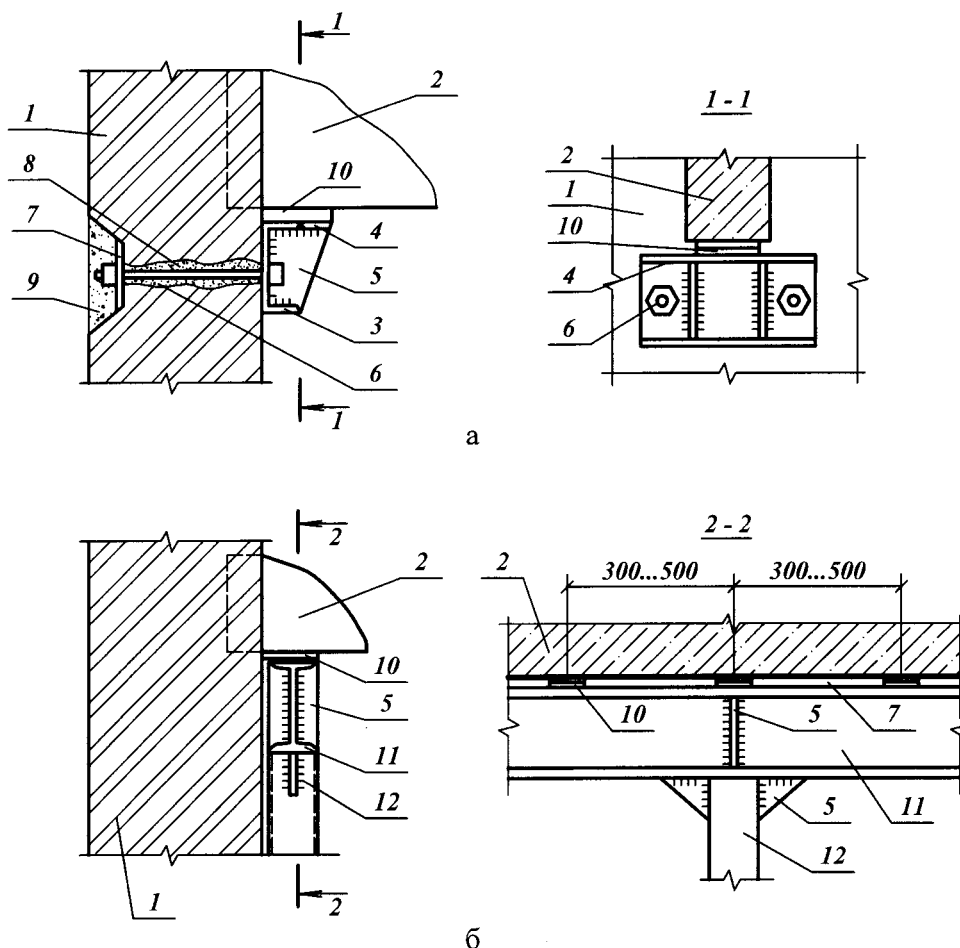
Усиление узлов опирания балок и плит на элементы каменных конструкций: а – установкой стальных столиков; б – подведением балок на стойках; 1 – стена; 2 – несущая балка или плиты, не имеющие достаточной длины опирания на стену; 3 – опорный столик из швеллера; 4 – дополнительная пластина, приваренная к полке швеллера; 5 – ребра жесткости; 6 – анкерные болты; 7 – пластины-шайбы; 8 – отверстия в стене (заполняются цементно-песчаным раствором после установки болтов); 9 – ниша в стене (заполняется раствором); 10 – стальные пластины-клинья для включения столиков (балок) в работу; 11 – балка-опора из двутавра $\text{I}12\dots20$; 12 – стойки (труба, коробчатые сечения из уголков или швеллеров) через $1,5\dots3$ м; 13 – шов (зачеканивается цементно-песчаным раствором после подбивки пластин-клиньев)
